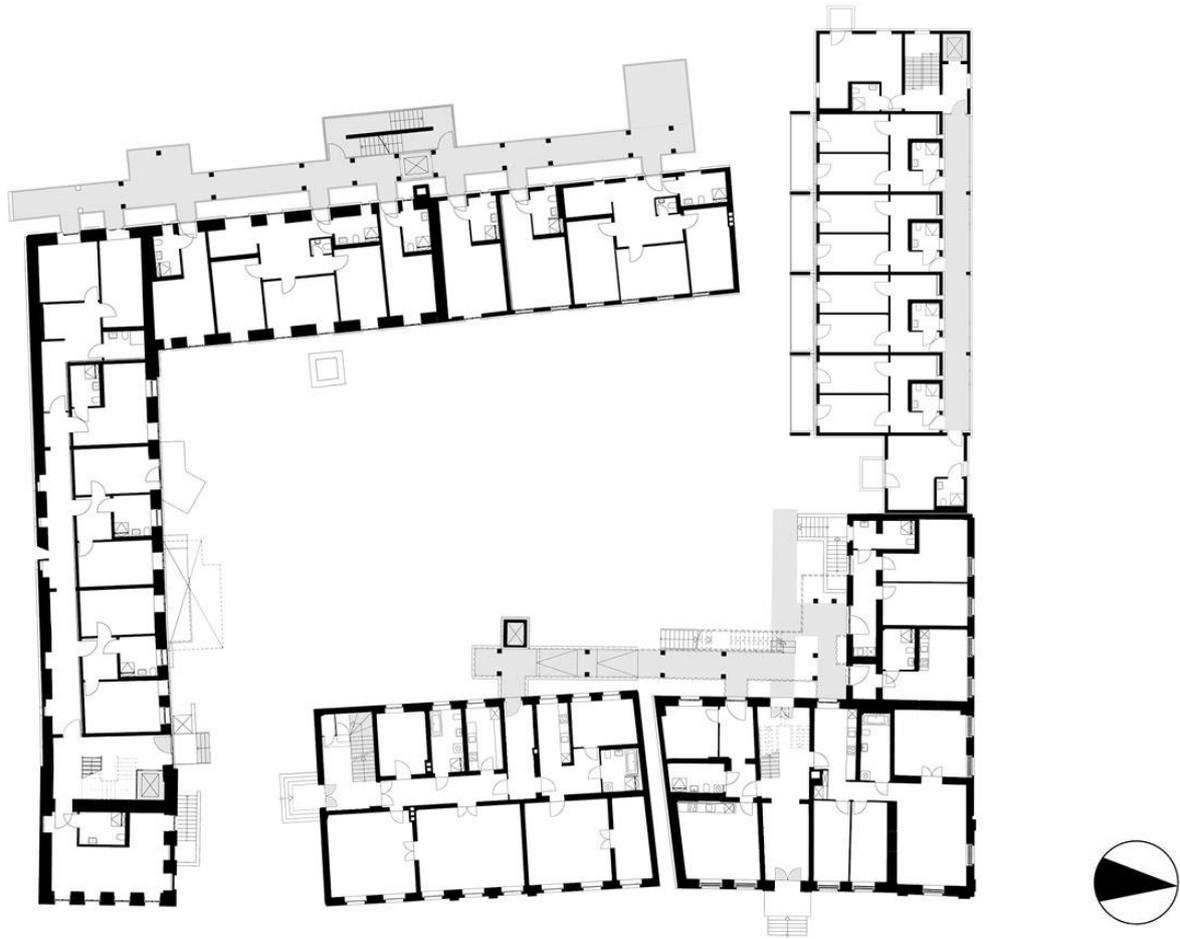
Grundrissdarstellung Haus 1 bis 8 (ohne Haus 7)
